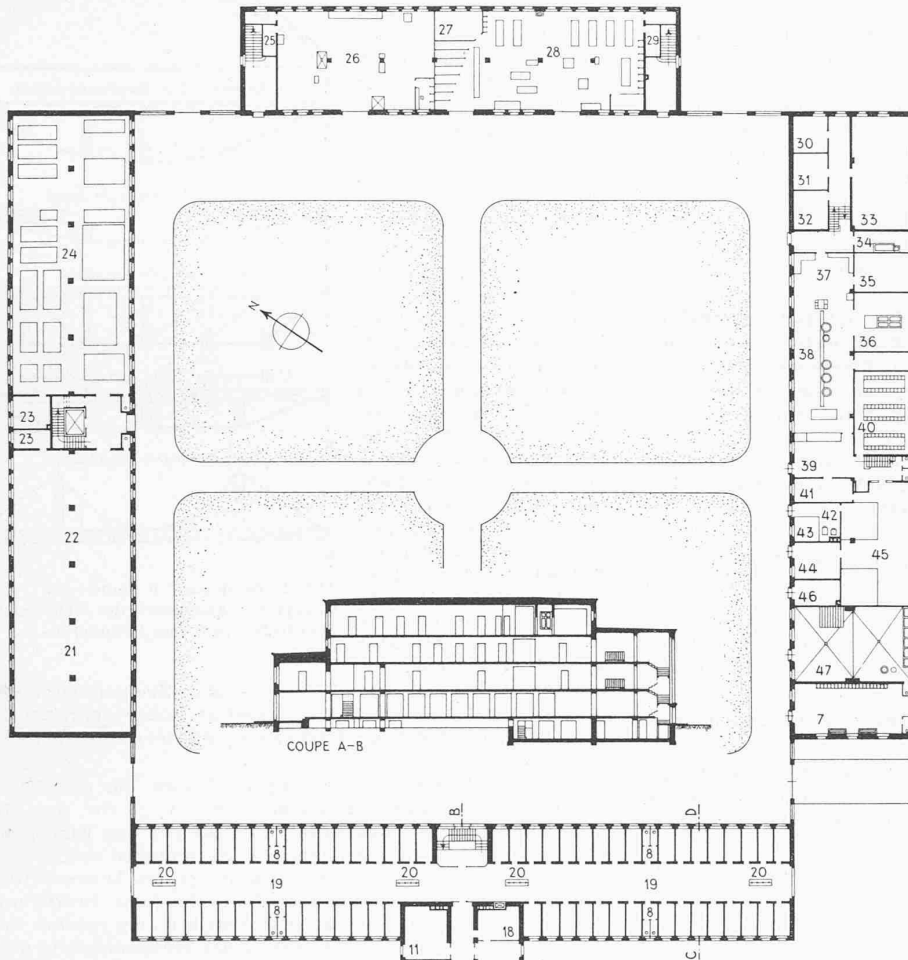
Plan du Rez-de-chaussée 1., 2. et 3. étage. — 1:800
